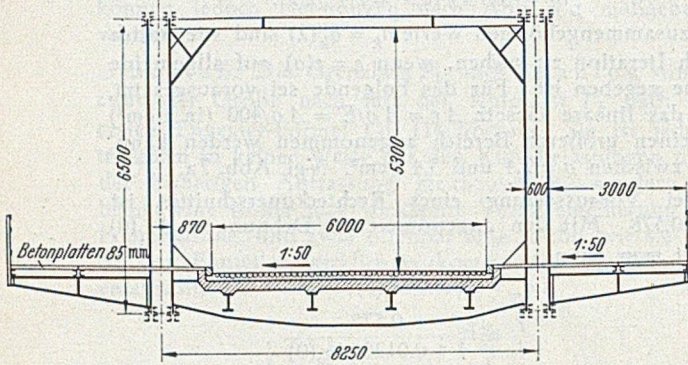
Umgebaute Eisenbahnbrücke in Straßenbrücke.
